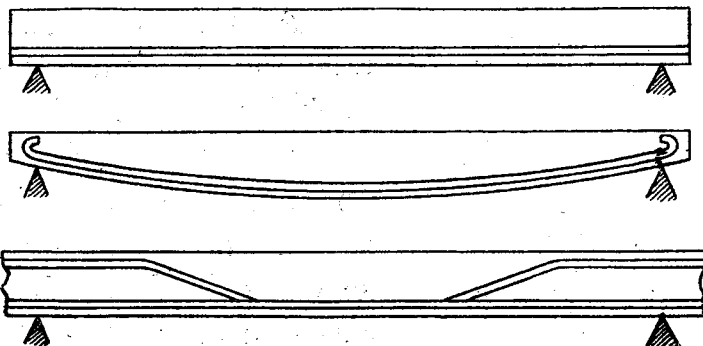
Sección transversal de una viga sencilla de hormigón armado.
